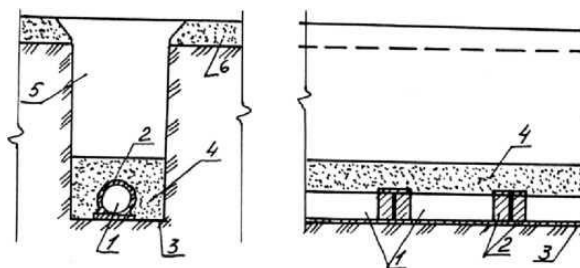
Керамическая дрена: а – поперечный разрез; б – продольный разрез; 1 – керамические трубы; 2 – защитно-фильтрующий материал; 3 – дно траншеи; 4 – присыпка гумусной почвой; 5 – обратная засыпка; 6 – пахотный слой
